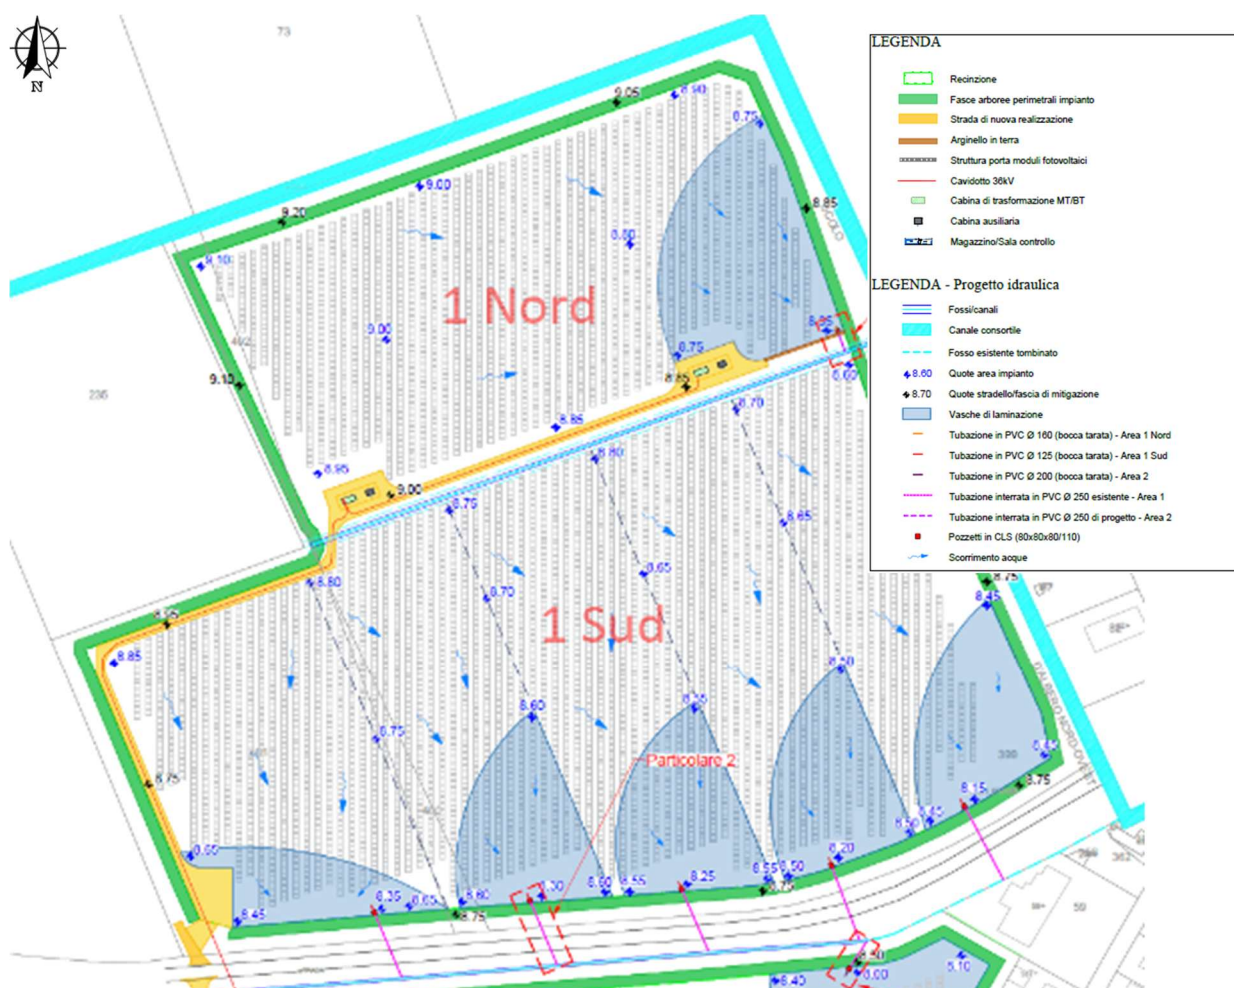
Planimetria area 1 con individuazione scarichi e vasche di laminazione (stralcio Tav. 43A)
